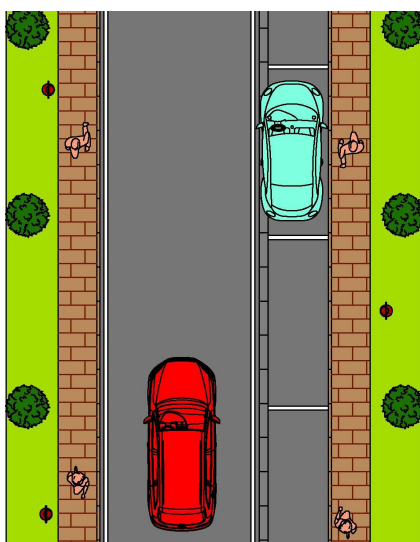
Planimetria progettuale con seconda ipotesi strada a doppio senso di marcia
